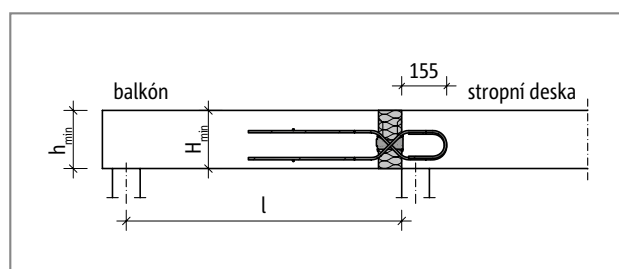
Schöck Isokorb® typ Q10S až Q30S: Statický systém
